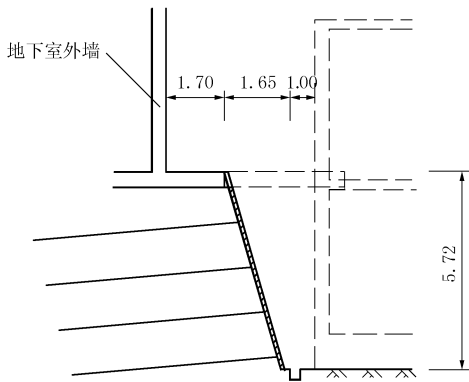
基坑西侧直接开挖喷锚支护剖面图(单位:m)
